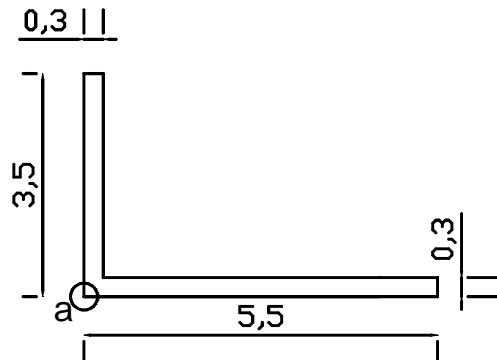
Dimensionamiento del muro de concreto armado (cotas en metros).
